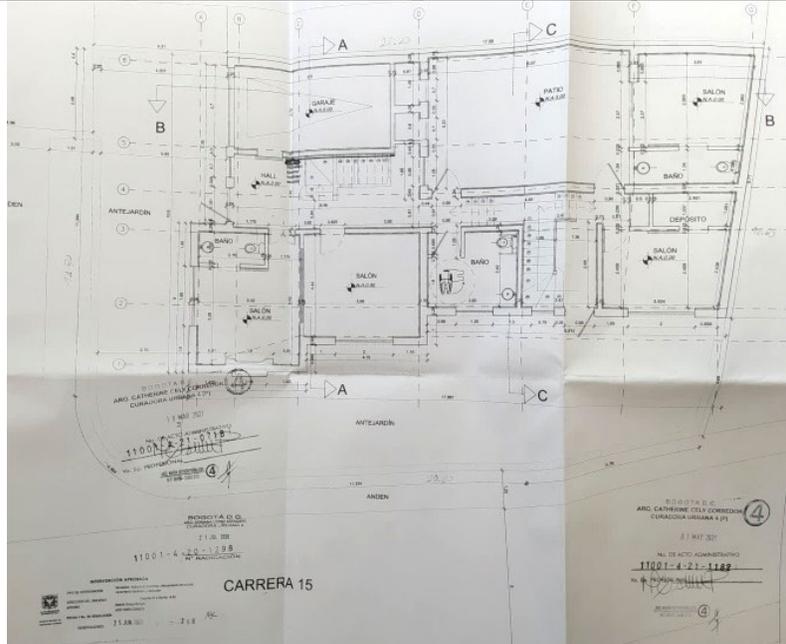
Plano de planta primer piso propuesta con sellos de la Licencia de Construcción No. 11001-4-21-1182. Fuente: Documentos de la obra Diagonal 40A BIS 14 83.
